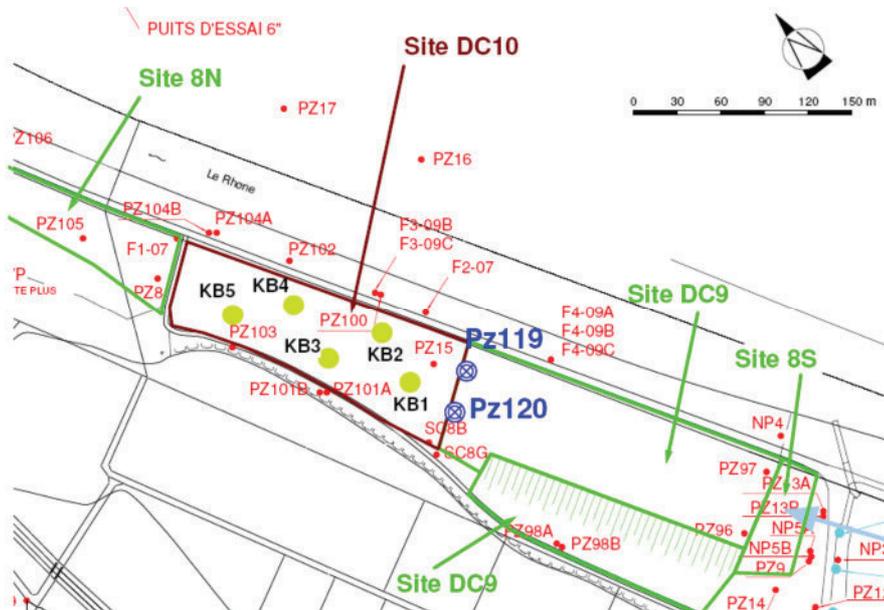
Situationslageplan mit Lage der Kernbohrungen (KB). (Fig. 3 in Originalbericht)
